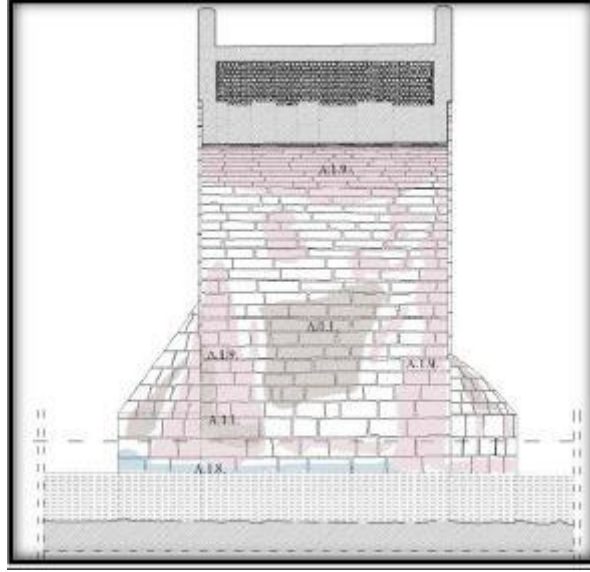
Murat Köprüsü Plan Görünüşü
